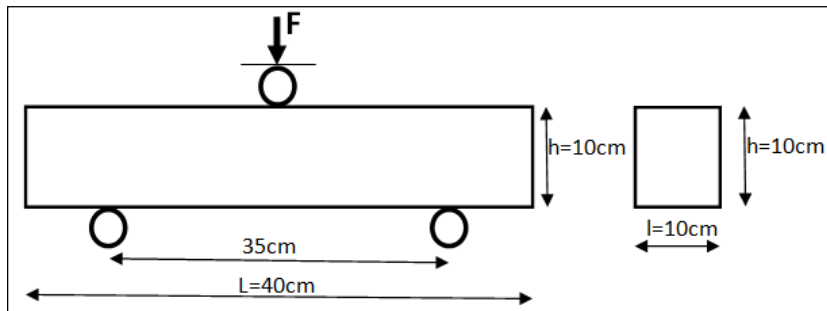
Schéma statique de l'essai de flexion trois points.
